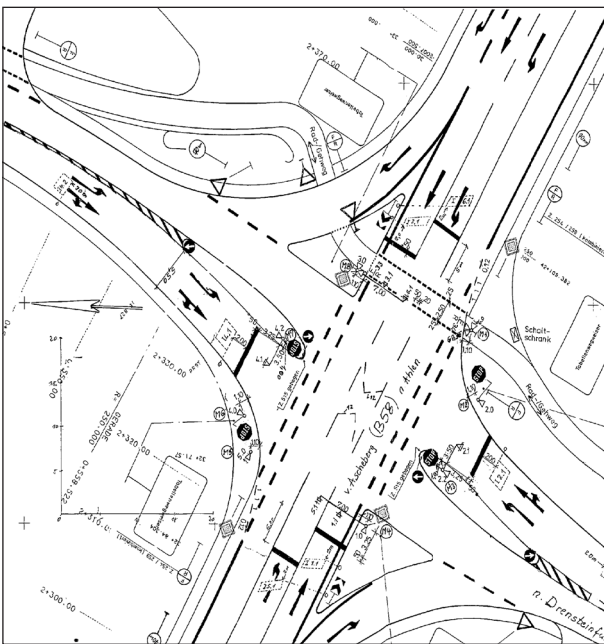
Signallageplan des Knotenpunkts B 58/L 585 in Drensteinfurt
